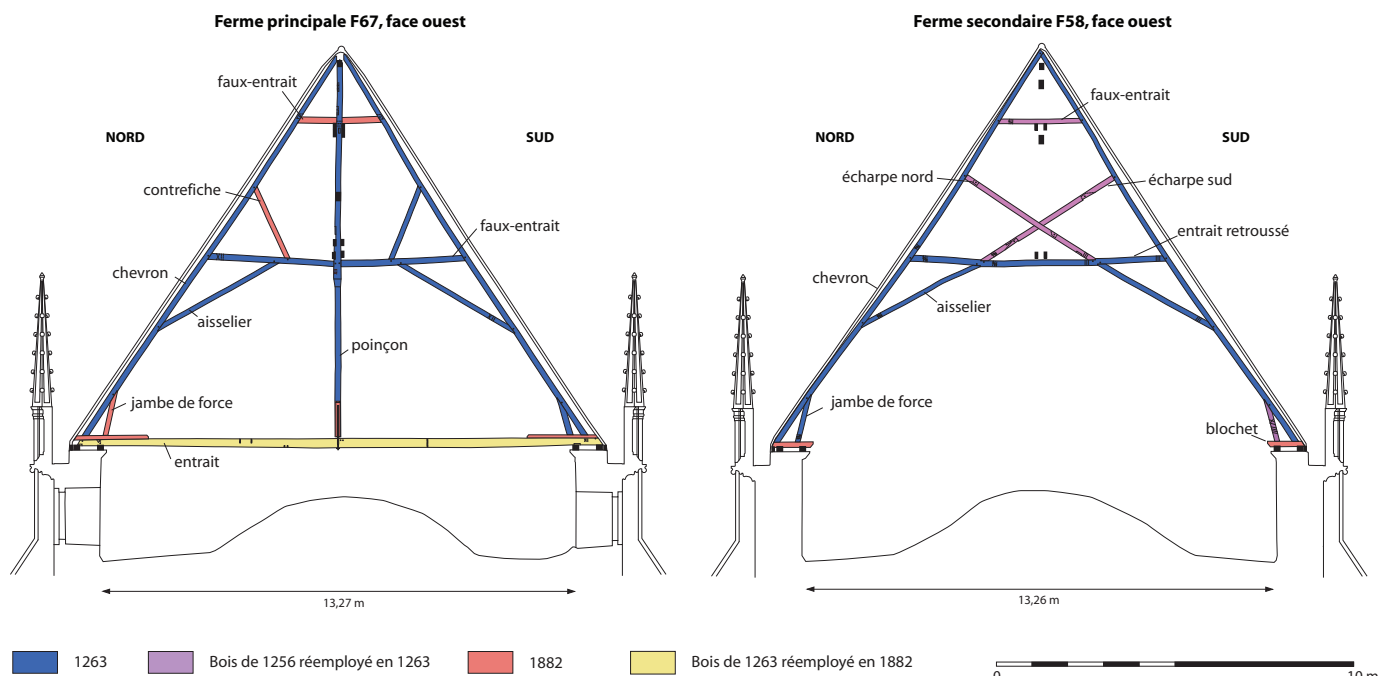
> Charpente attenante au faux-transept, ferme principale 67 et ferme secondaire 58, face ouest. [Relevé et DAO : F. Épaud.]
